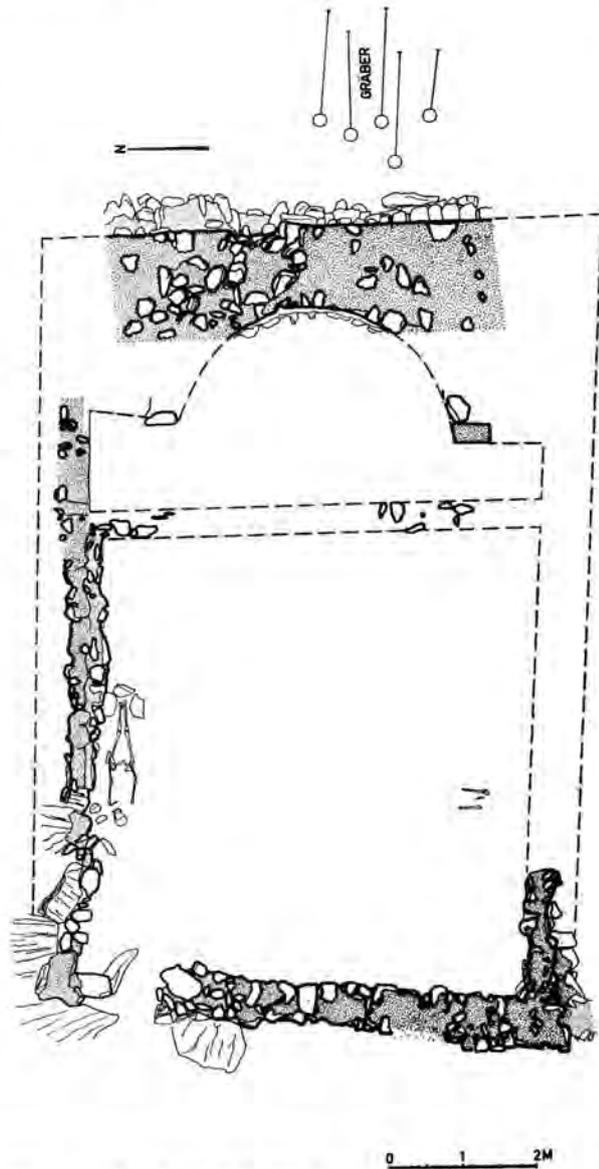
Ruschein GR, Kirche Son Gieri. Grundriss der 2. Kirche aus dem 8./9. Jh. – 1:100.
